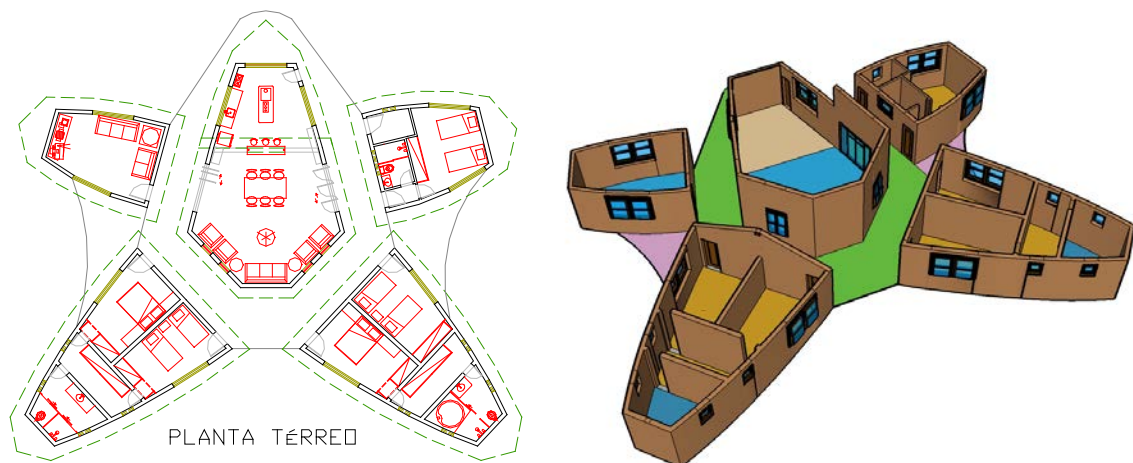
Croqui da planta e perspectiva das alvenarias em adobe solo-cal
